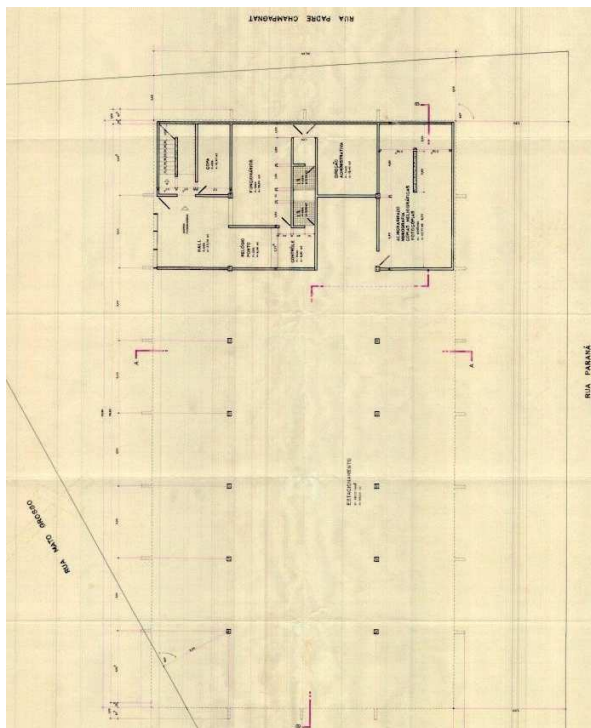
Planta pavimento térreo – Projeto arquitetônico 1971
